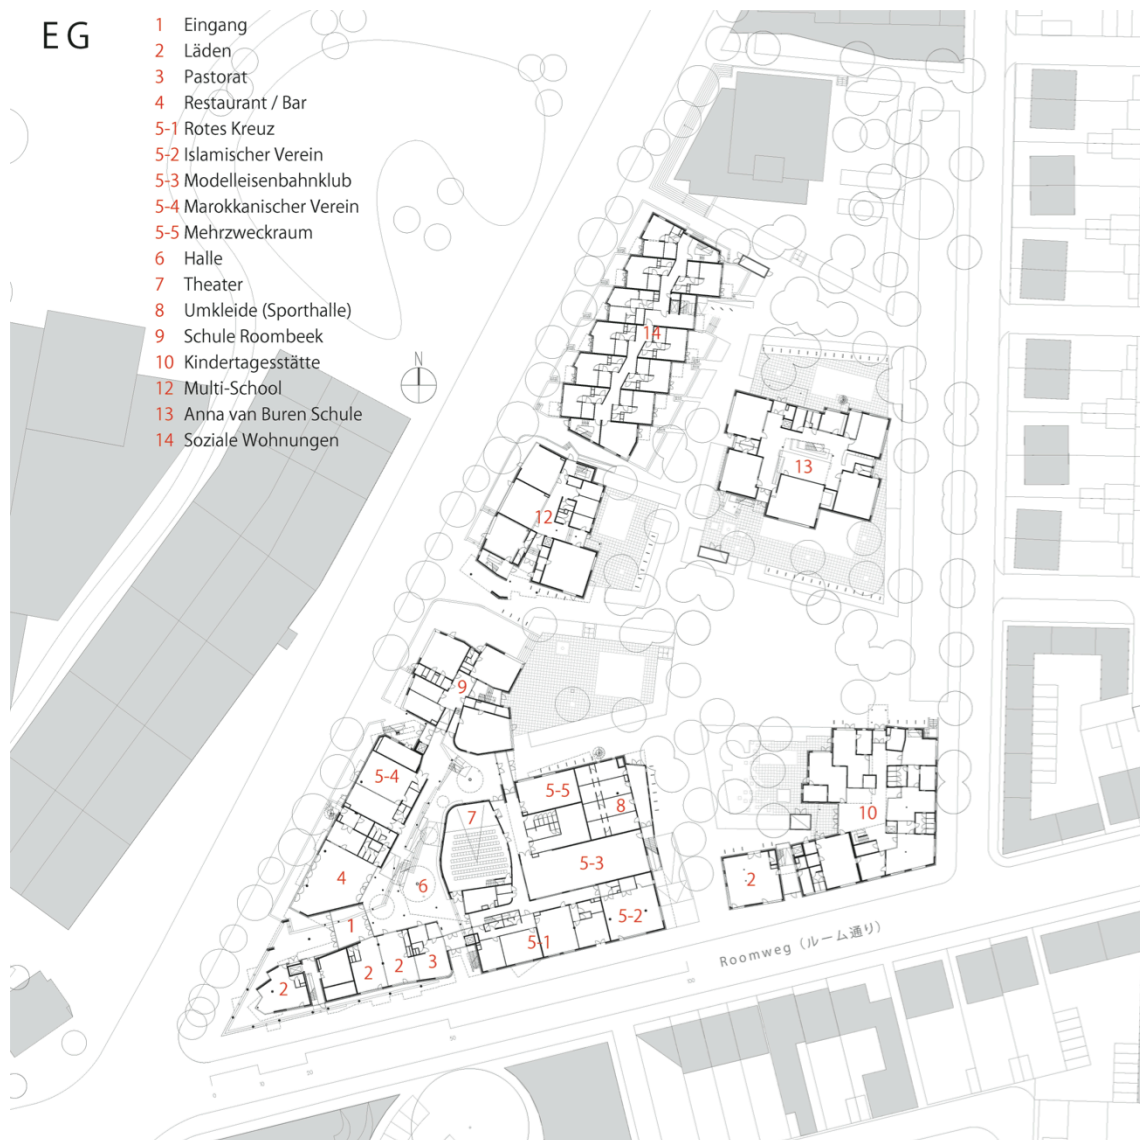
Grundriss Erdgeschoss (Von plus+ bauplanung GmbH)
